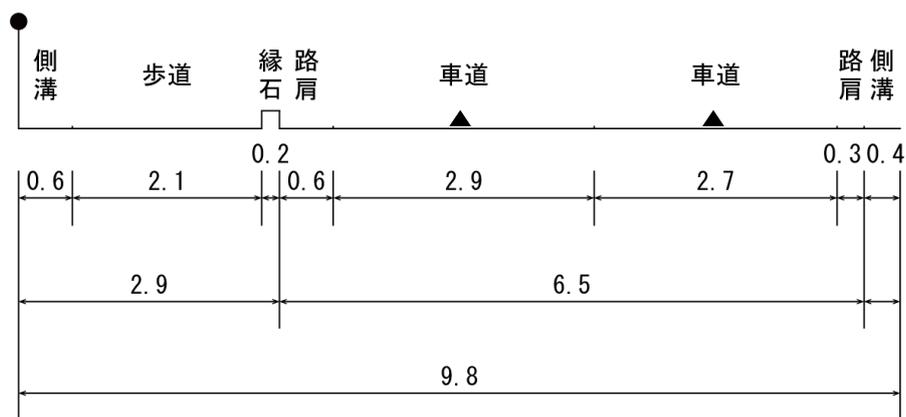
音源配置図 (道路延長方向の配置イメージ)
